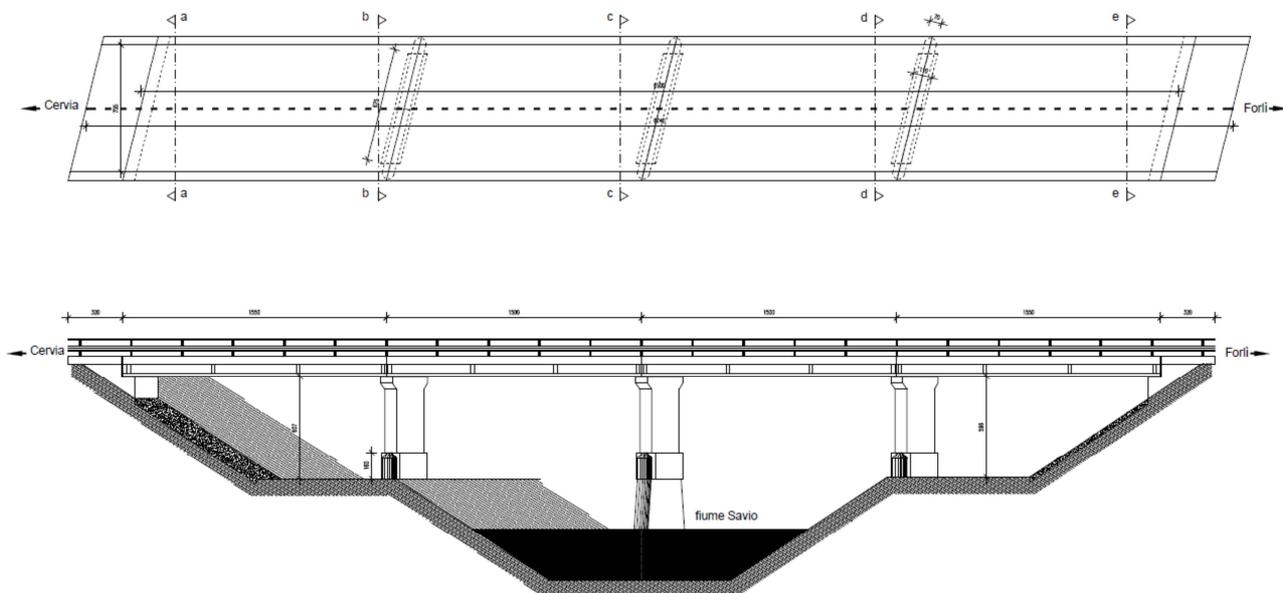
Pianta impalcato e sezione longitudinale del ponte
